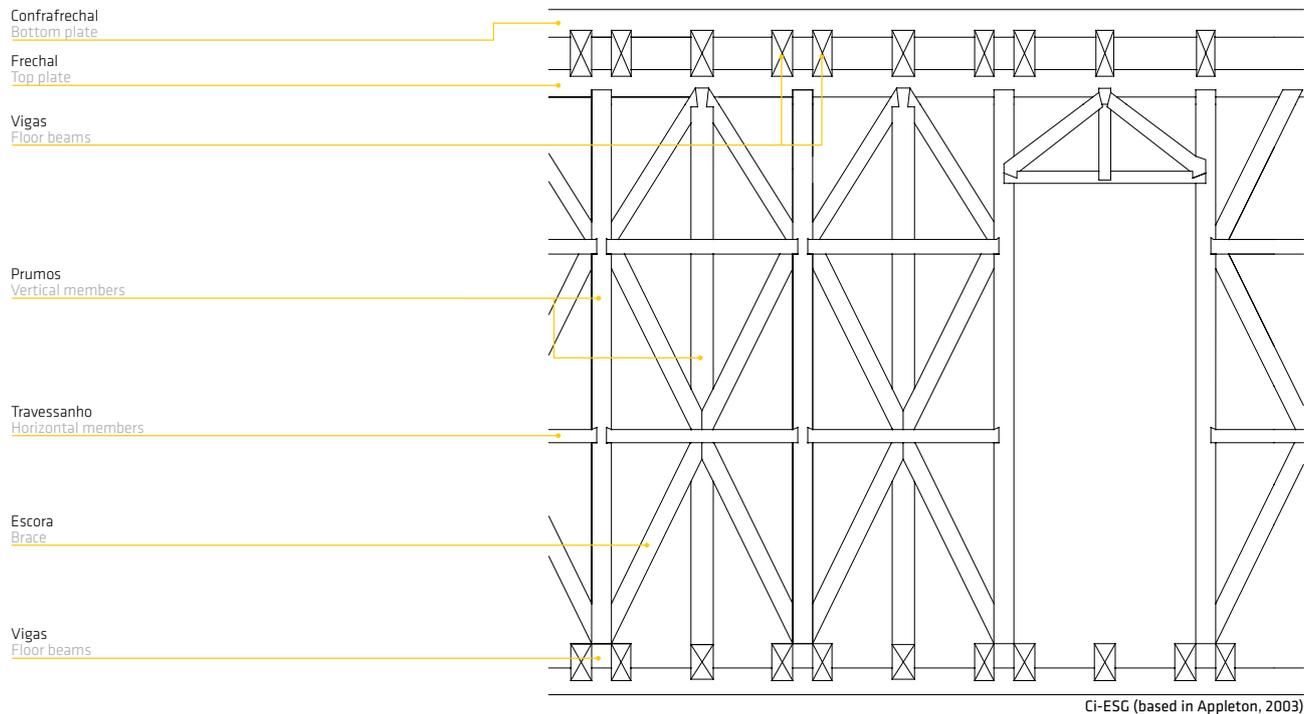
Estrutura interna de uma parede do sistema 'gaioleiro' Internal structure of a 'cage system' wall
